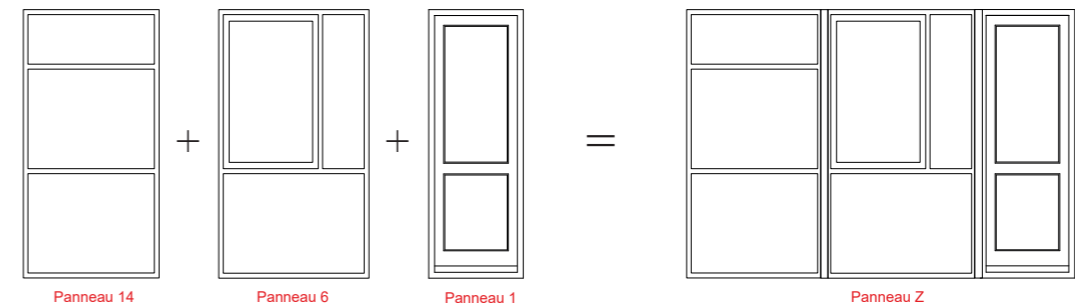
Illustration du principe d'assemblage des panneaux de façade; ici, l'assemblage du panneau « Z »
